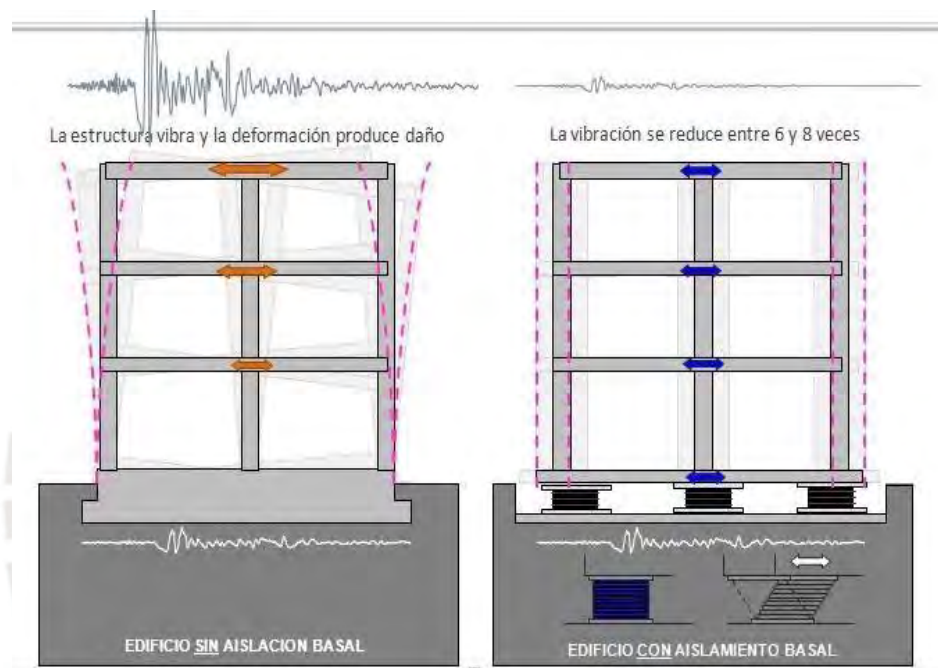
Diferencia en la conducta de una estructura aislada y una estructura sin aislar.
